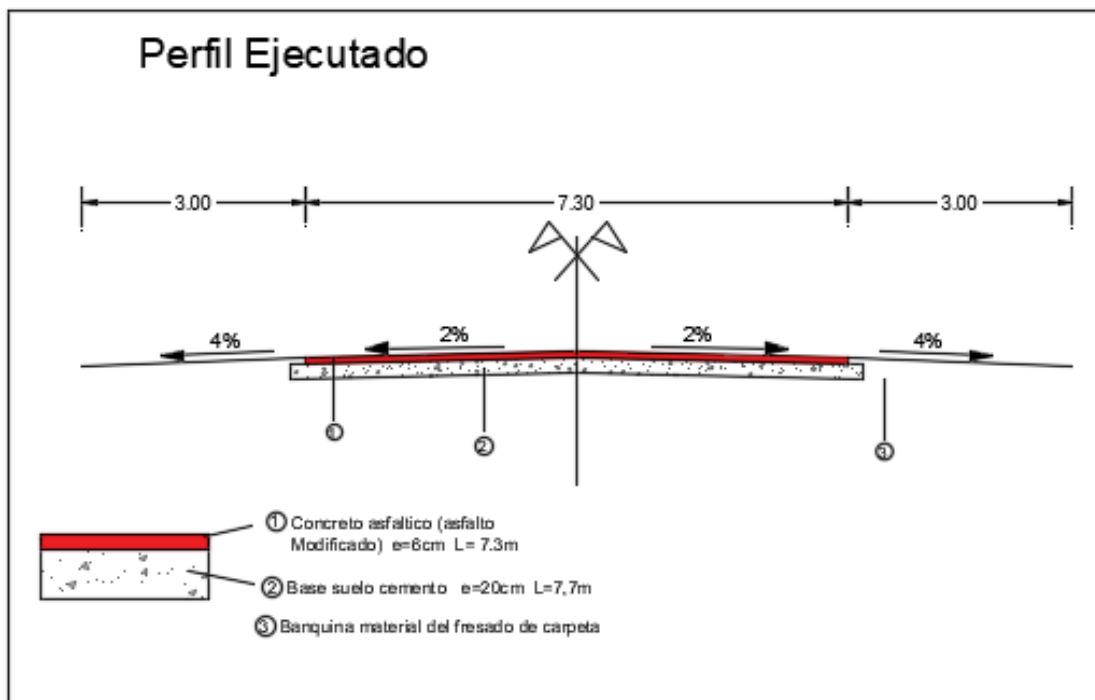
Perfil transversal Ejecutado por la Empresa Constructora y aprobado por D.P.V.
